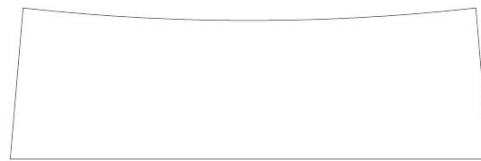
Geometría aproximada de los bloques desde el alzado.
